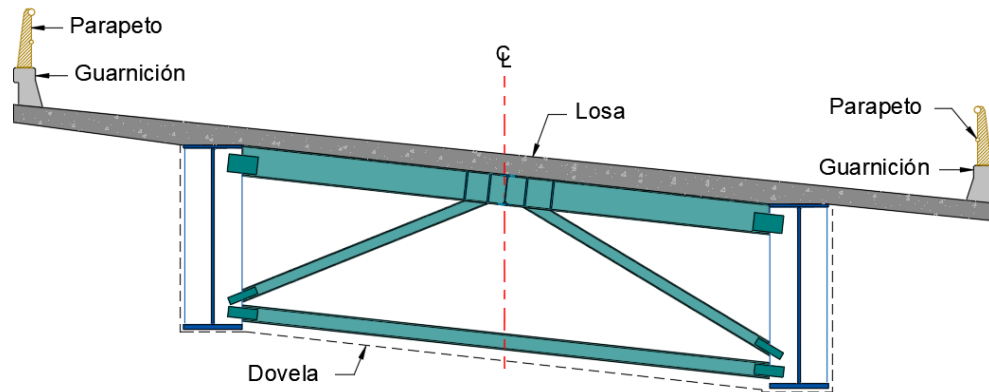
Construcción de la losa, guarnición y parapeto. Fuente: Elaboración propia.
